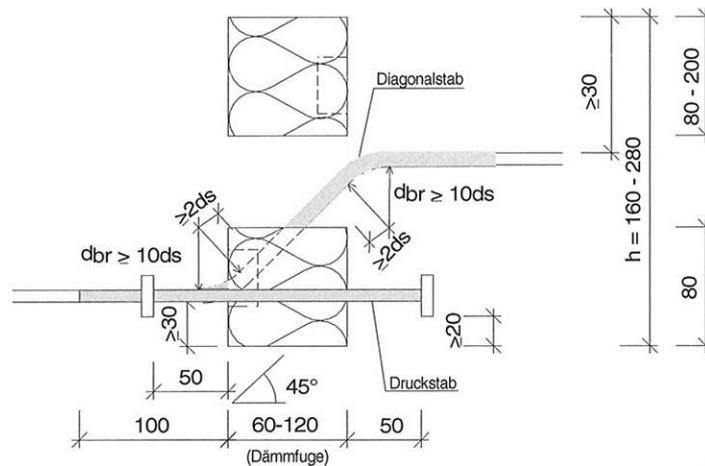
Egccobox Plattenelement Typ PV-DD-F
